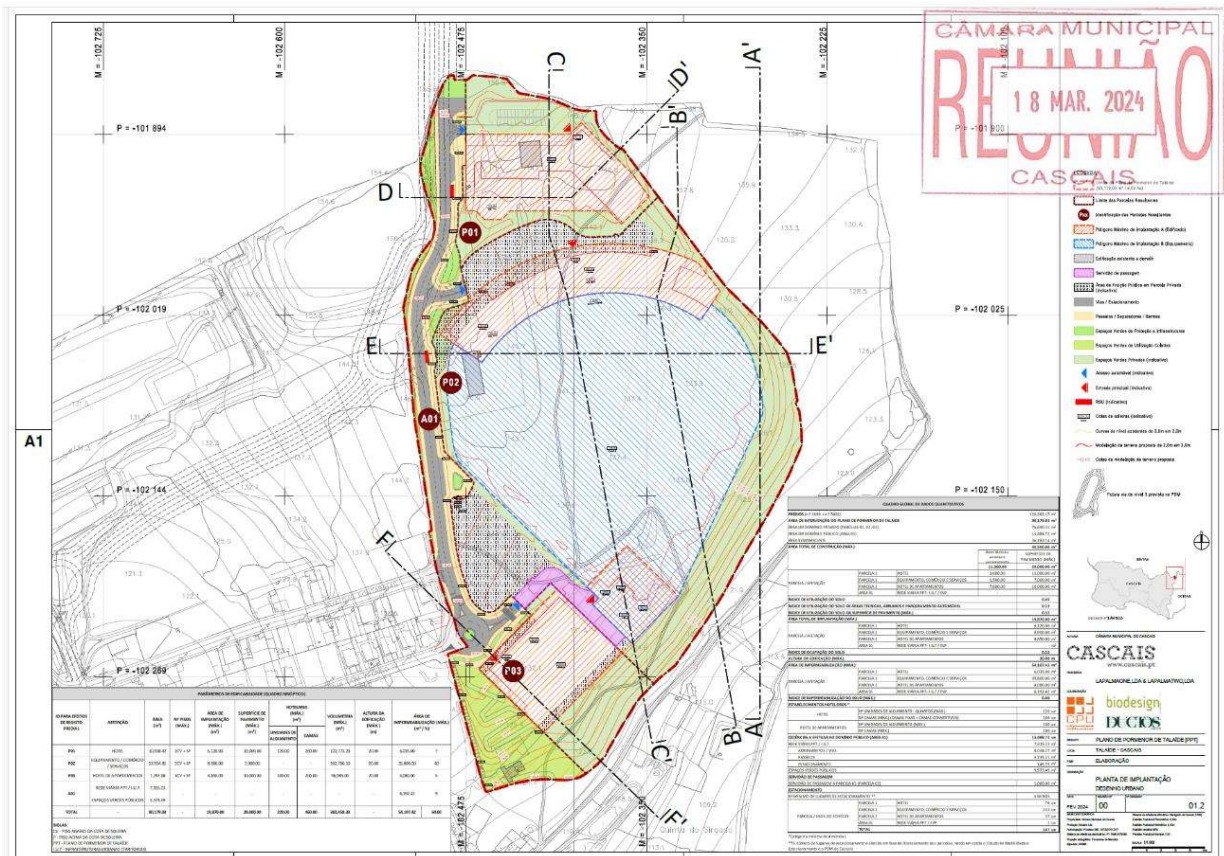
Planta de Implantação do Plano de Pormenor de Talaíde
